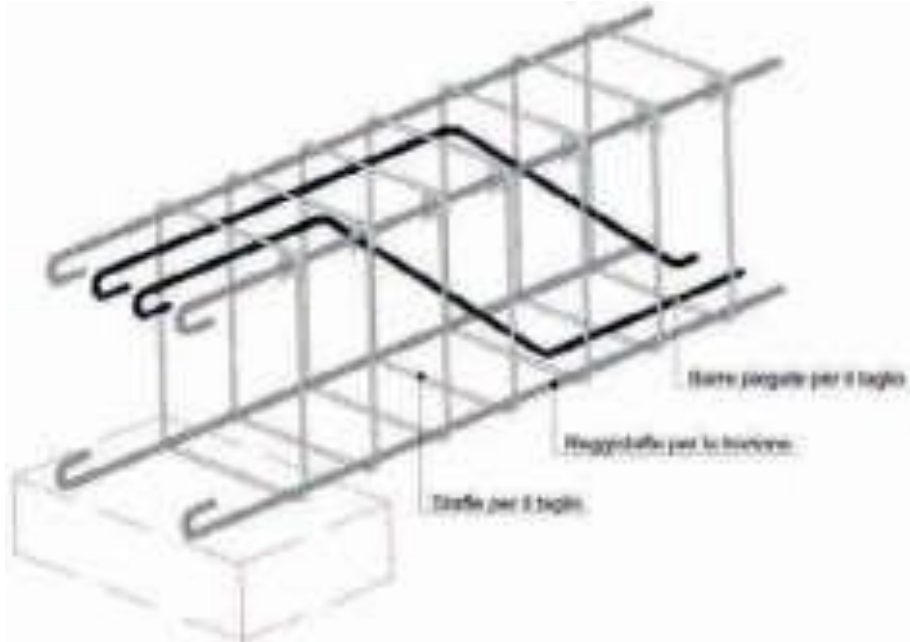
Disposizione dei ferri di armatura in una trave di calcestruzzo.
